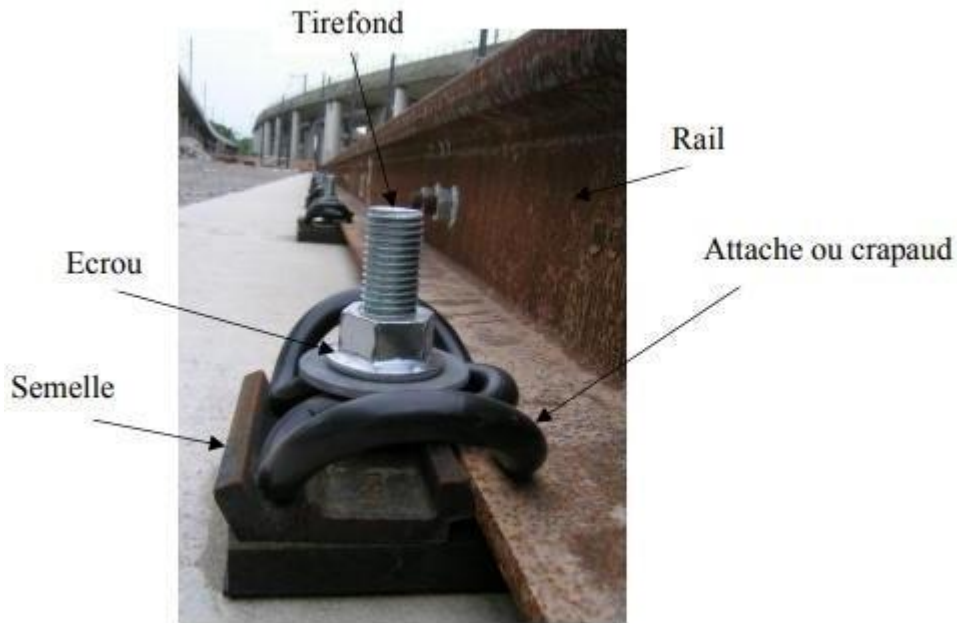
Fixation du rail Vignole sur traverse en béton.
